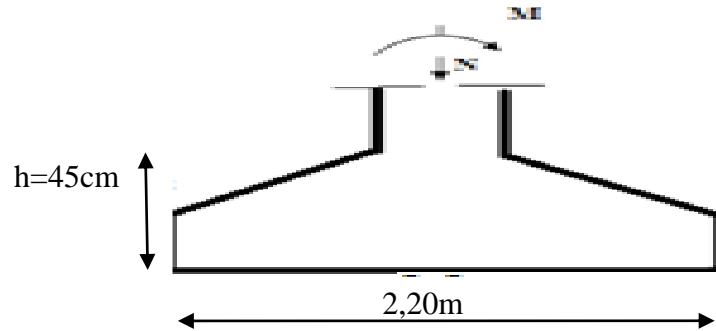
Coupe type semelle isolée S1 (2,20x2, 20)
